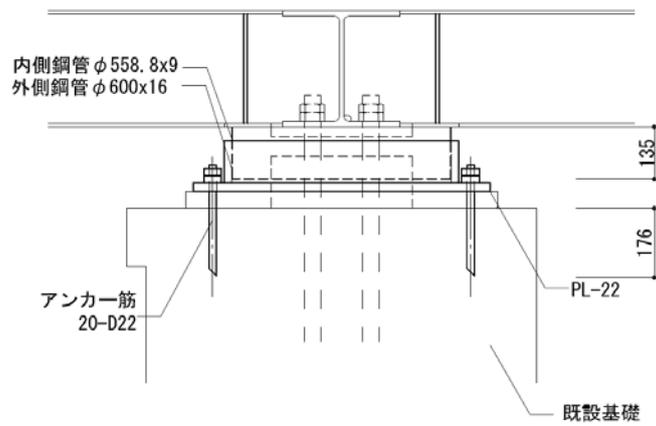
補強鋼管とあと施工アンカー詳細 (断面図)
